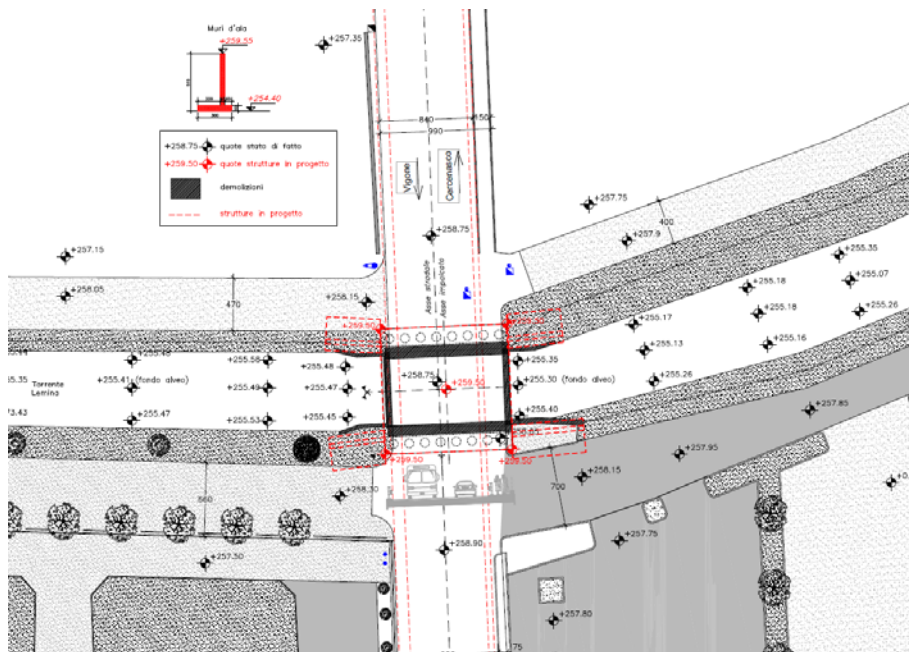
Planimetria degli interventi di carattere strutturale in progetto.
